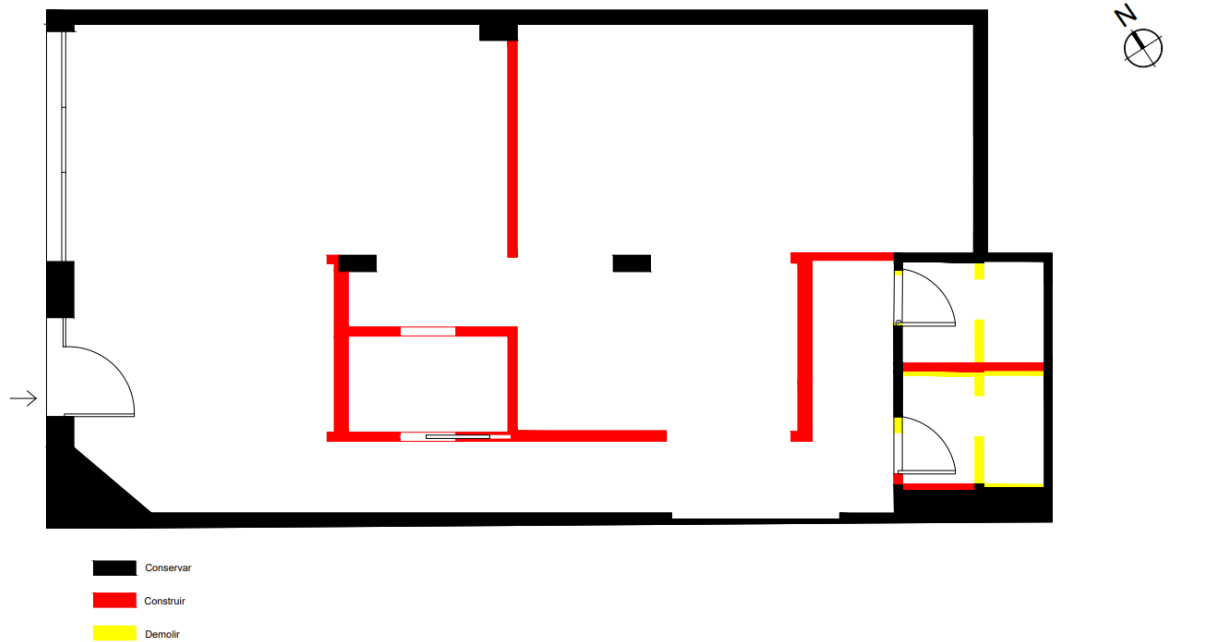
Planta de Alteração. Fonte: Rafael Cos
